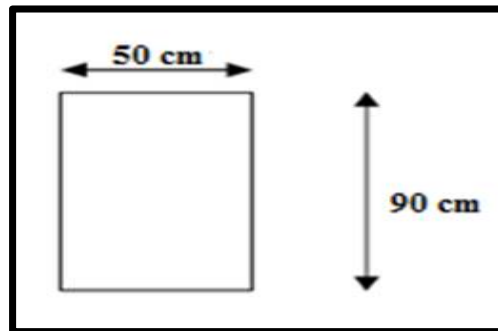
Schéma d'une coupe transversale en travée et en appui.
